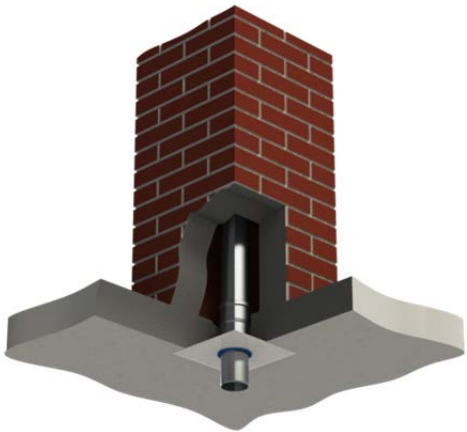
Plaque B₂ pour Cox-Aluminium – Montage Plafond
